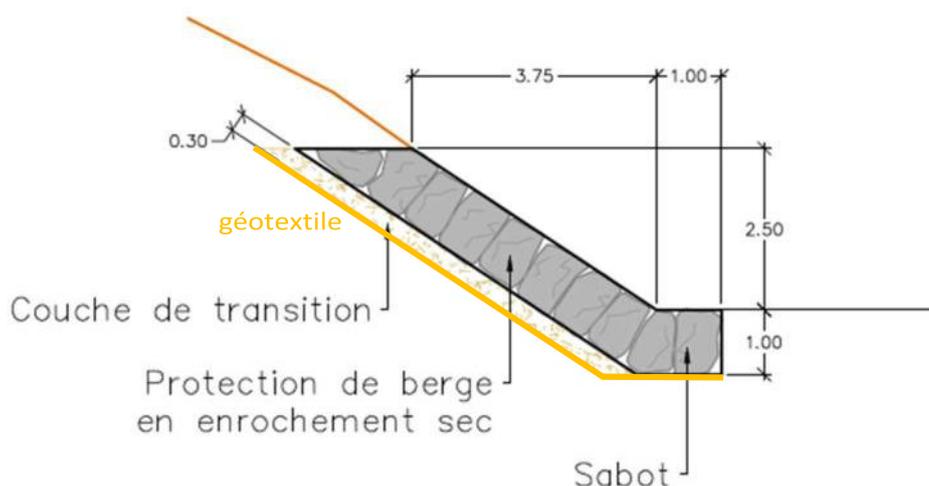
Schéma de principe de la protection de berge au niveau de la plage de dépôt
